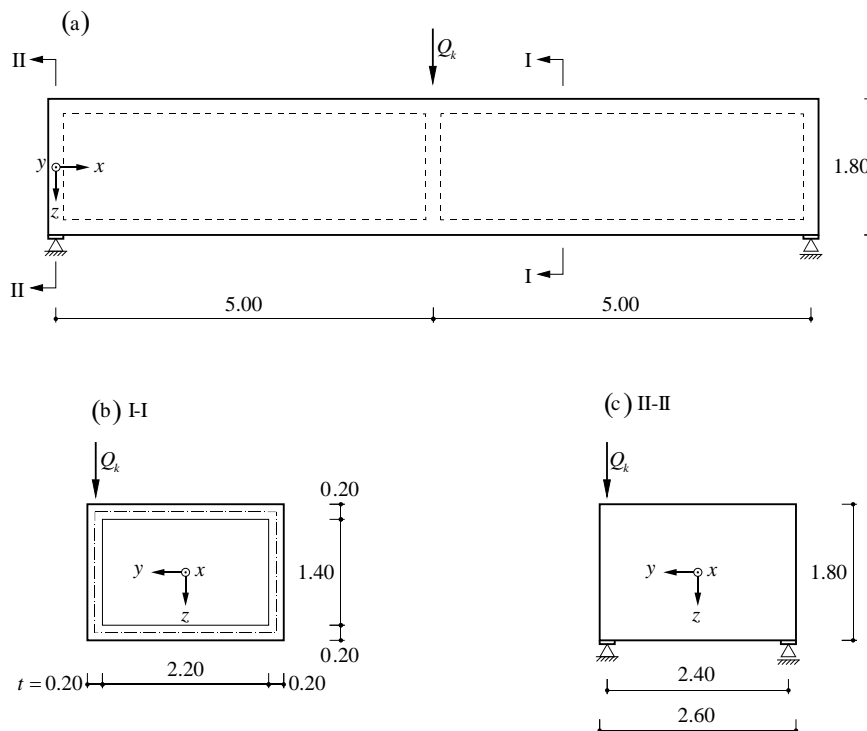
(a) Ansicht; (b) Querschnitt I-I; (c) Querschnitt II-II (Abmessungen in m)
